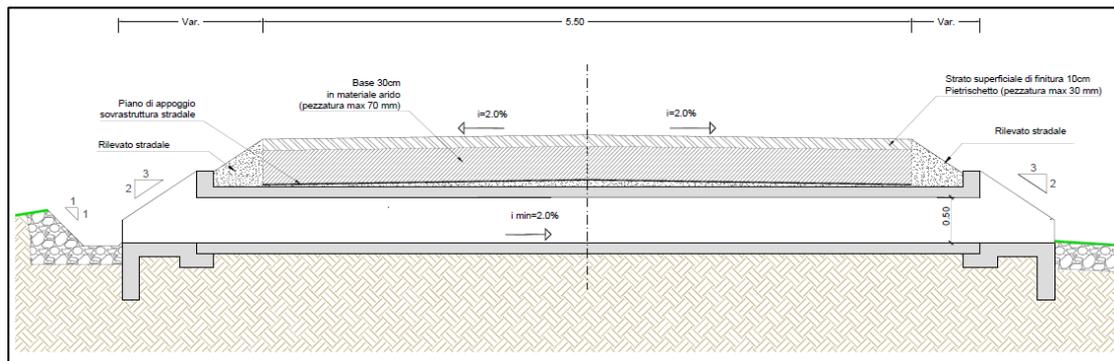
Sezione tipica di sezione stradale con condotta di attraversamento estratta dal progetto
